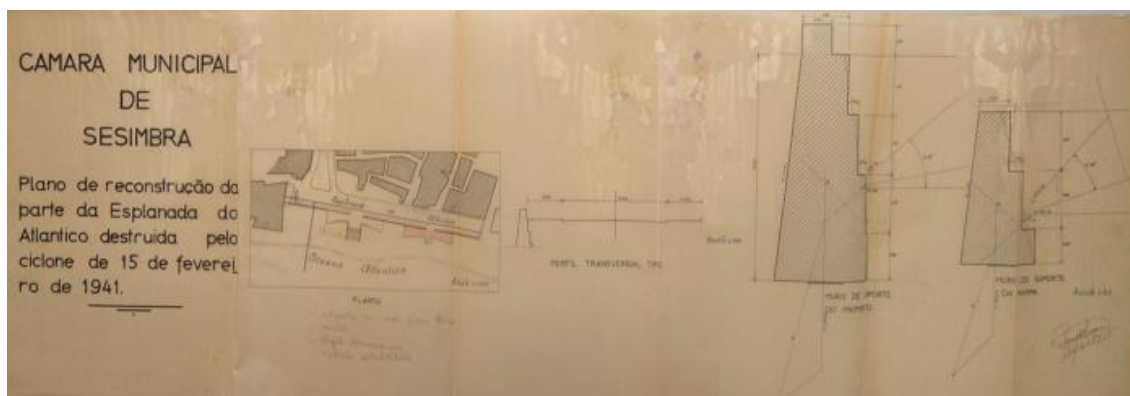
Perspetiva em planta e em corte dos pormenores de construção, a poente, do novo muro para proteção da vila face ao oceano. Com construção da respetiva rampa para varadouro das embarcações e acesso ao areal. AMS|FCMS/L/B/10/Cx_02.
